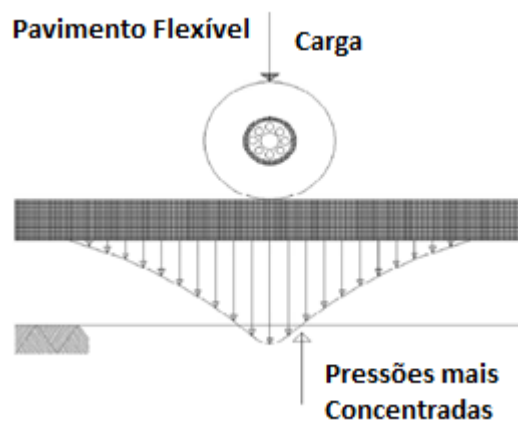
Distribuição de tensões nos pavimentos flexíveis (fonte: Jacob, 2017).
